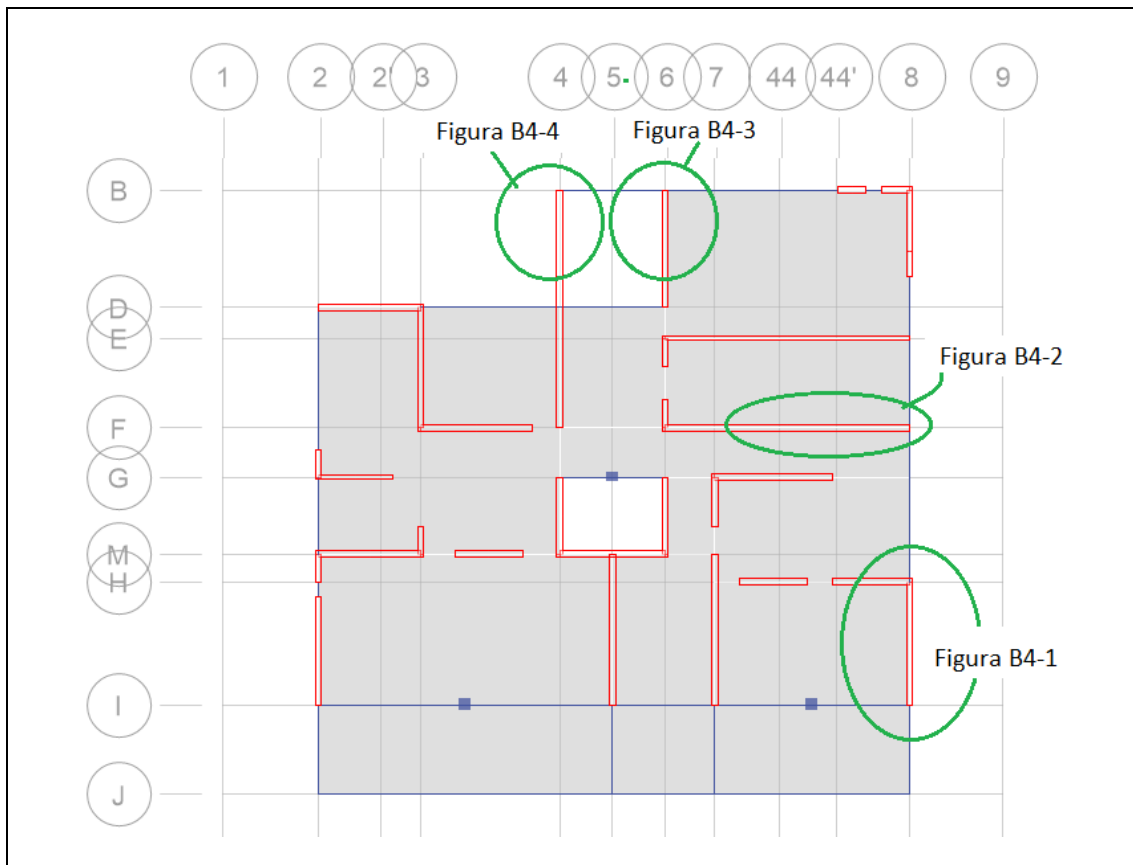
Edificio B4, planta piso 1, se indican los elementos dañados
